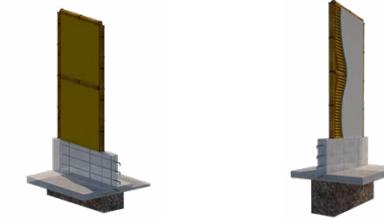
[Figura] Mampostería Fuente: Autor
